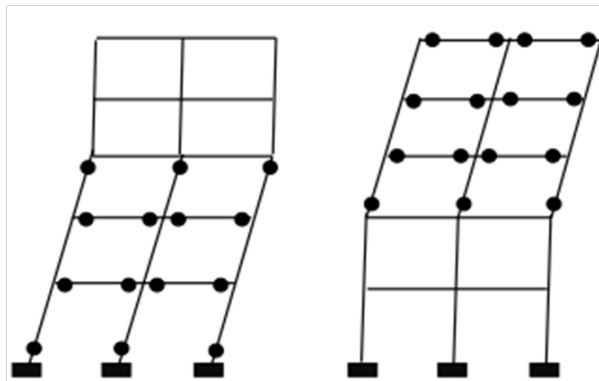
Mécanisme relatif à la rotation des poutres et des poteaux
